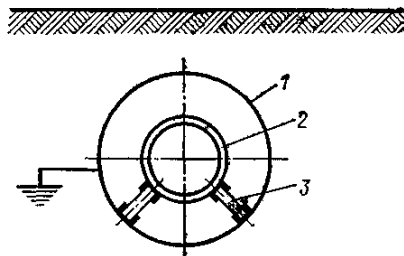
Схема размещения трубопровода в металлическом футляре: 1 – футляр; 2 – трубопровод; 3 – диэлектрическая опора
